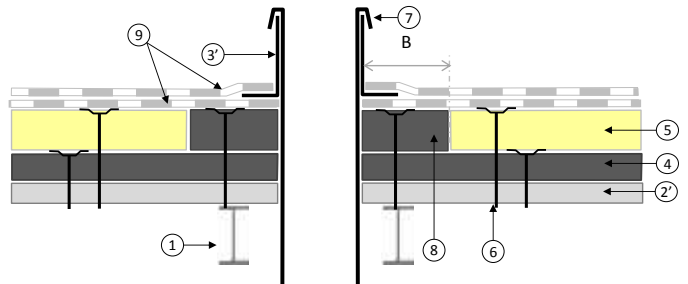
b – Calfeutrement des conduits avec fourreau rapporté sur TAN
